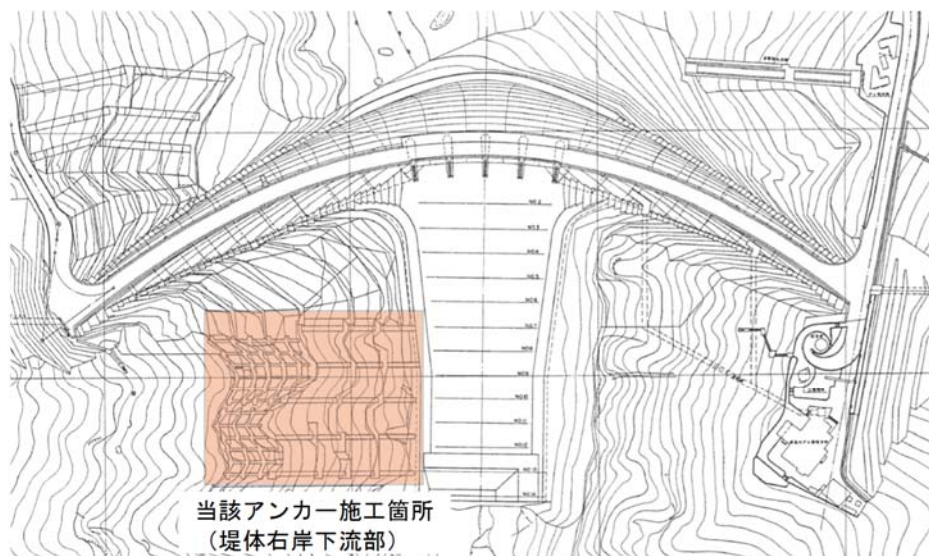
基礎点検により得られた岩盤補強用アンカー位置図及び平面図 (Mダム)
